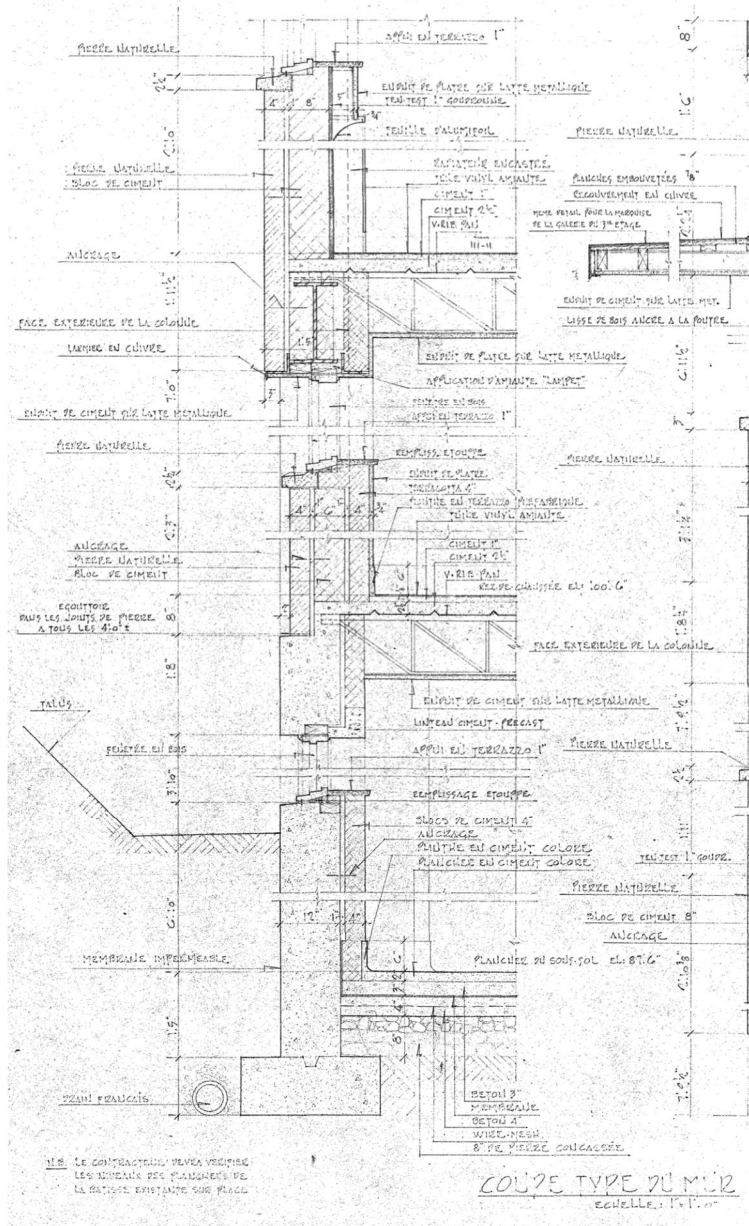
Coupe typique de la rive du bâtiment - (Claude Gagner, Architecte)
